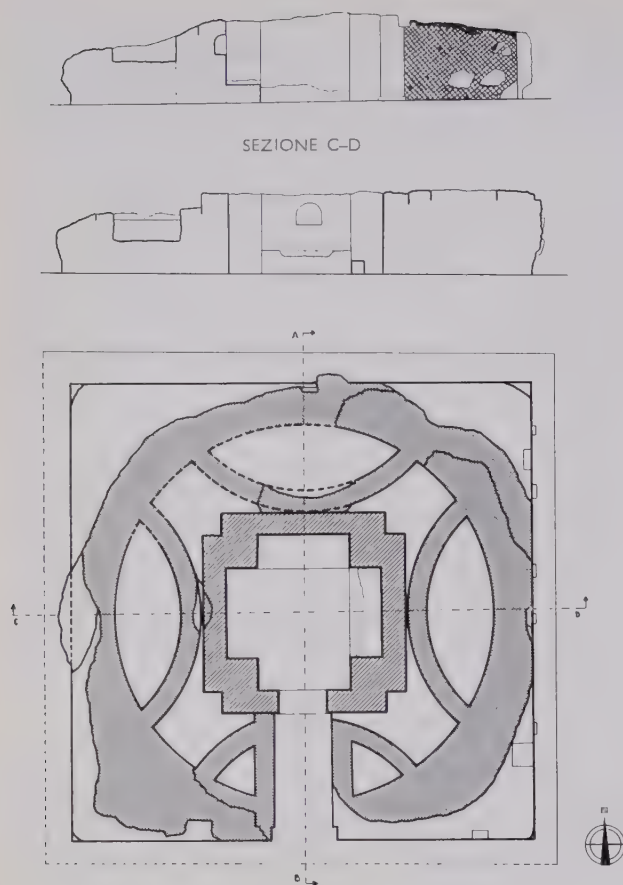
Canosa, Mausoleo - Pianta e sezioni
